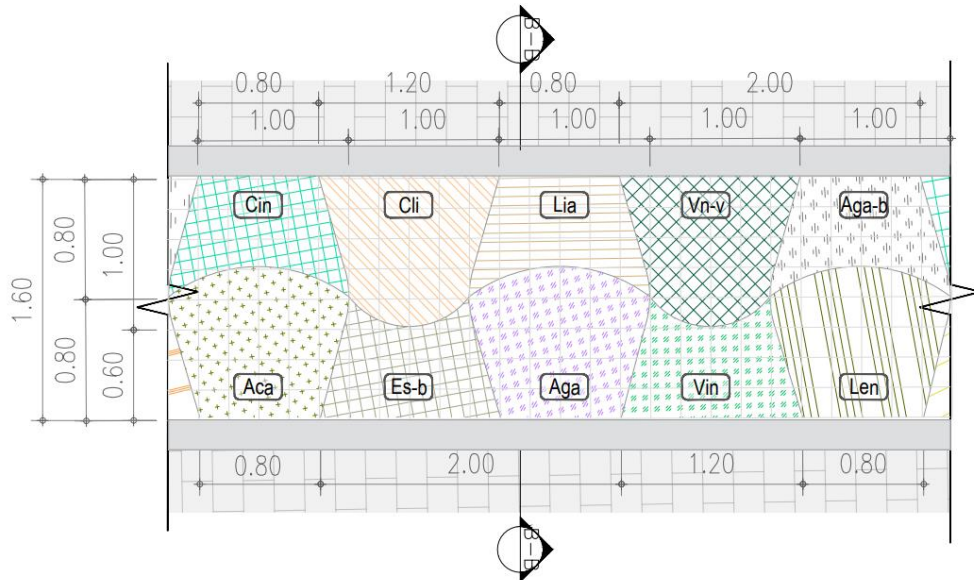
Planta detalle tipología Jardín lineal en estaciones
